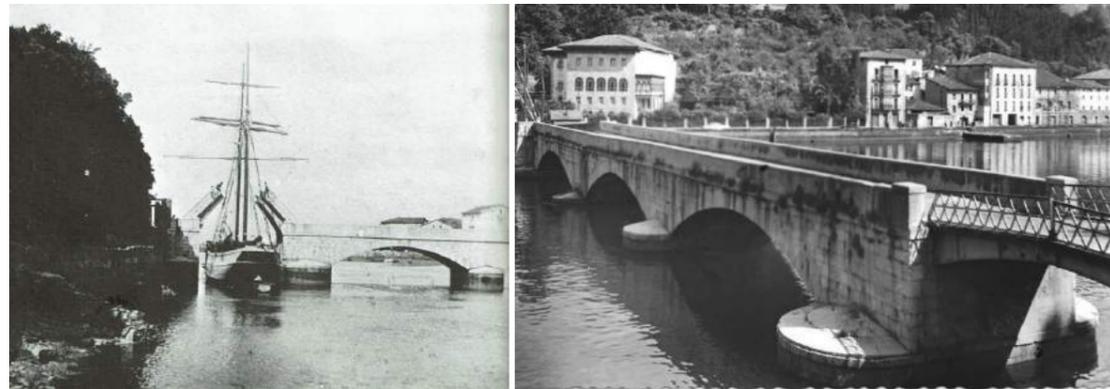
Izquierda, tramo levadizo abierto para el paso de la embarcación. Derecha, vista en escorzo del alzado de aguas abajo desde la orilla de Mutriku. Fuente: José María Izaga, ingeniero debarra.
